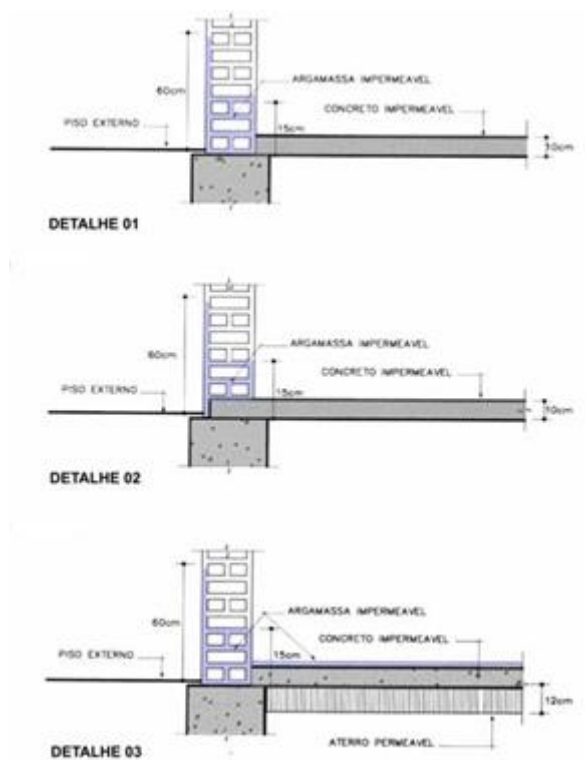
impermeabilização embasamento de alvenaria nível do solo
